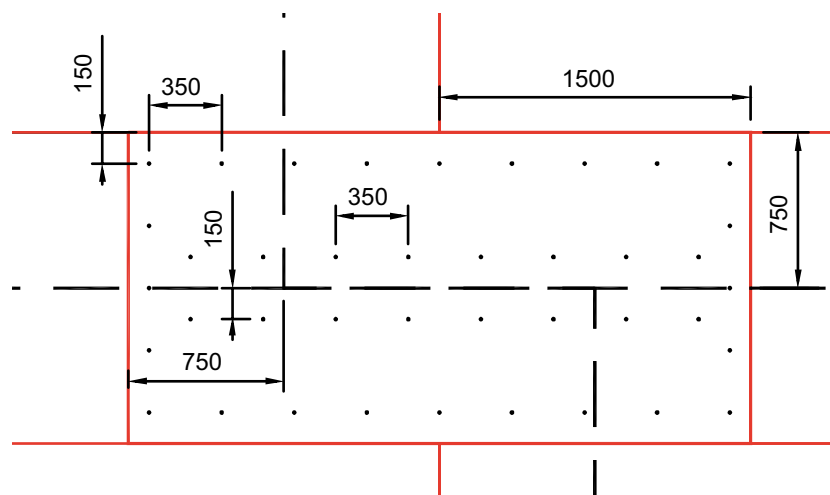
Схема раскладки и крепления листов сборной стяжки из АЦЛ (ЦСП)
